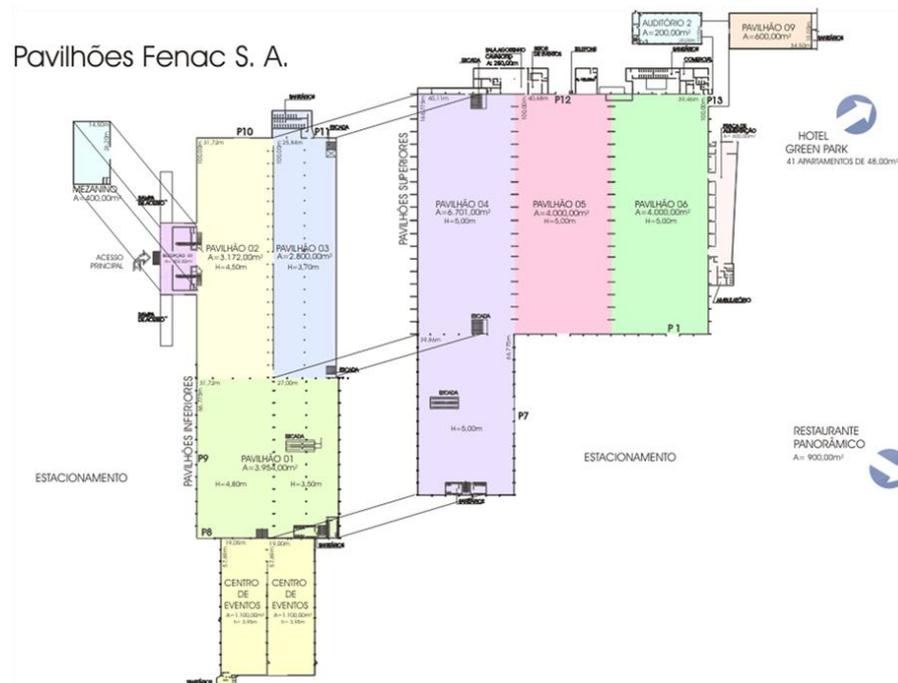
Planta Baixa dos Pavilhões da FENAC
